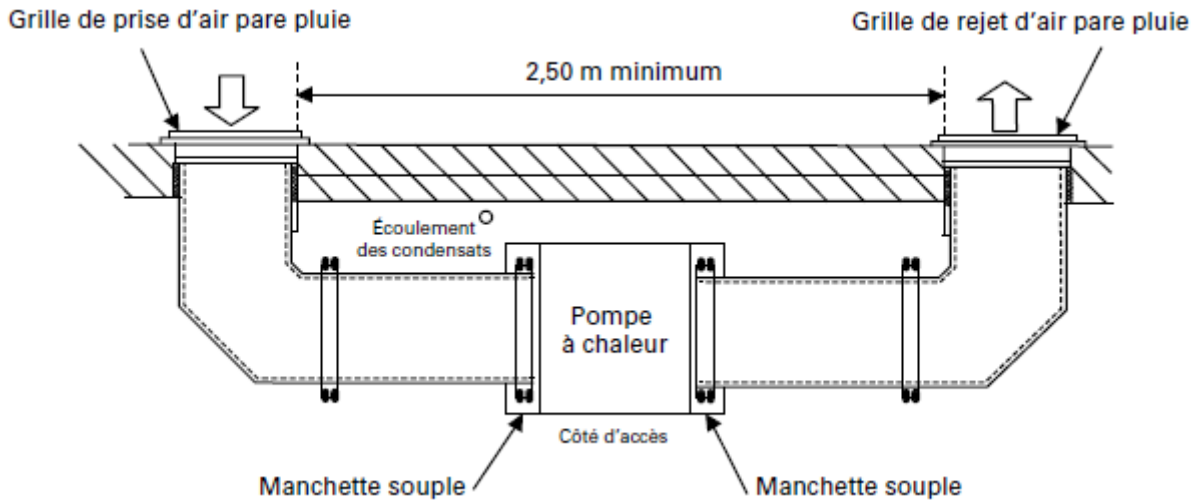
Exemple de disposition des grilles de prise d'air et de rejet d'air sur la même façade (vue de dessus)
